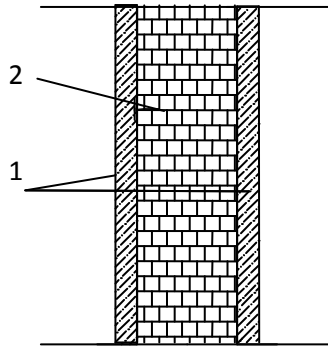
Coupe verticale d'un mur extérieur
